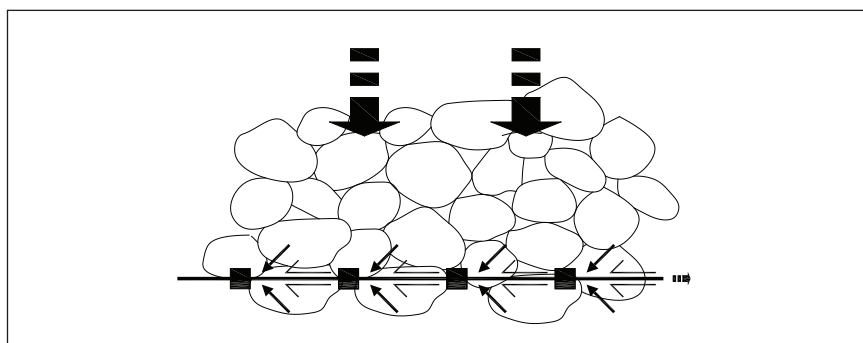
Detalle de la interfase geogrieta-base de pavimento
